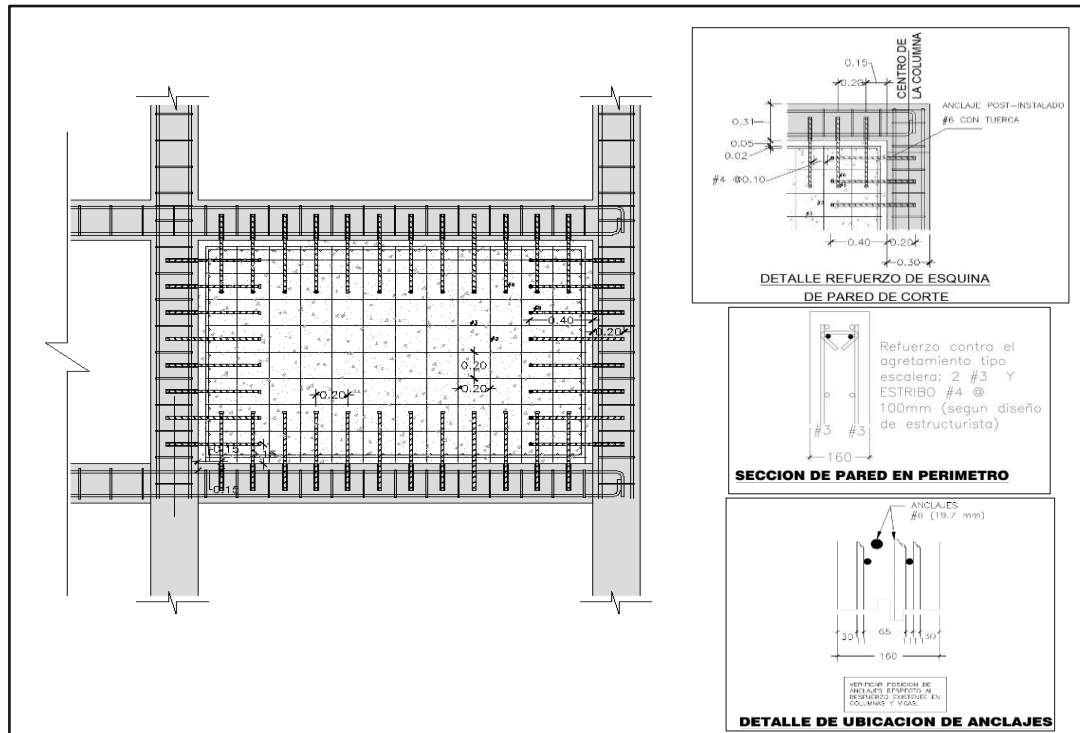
Detalle típico de pared de corte y sus conexiones con vigas y columnas existentes
